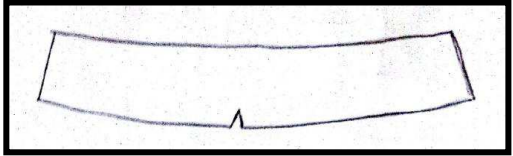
Esquinas de viga partidas. Fuente:
